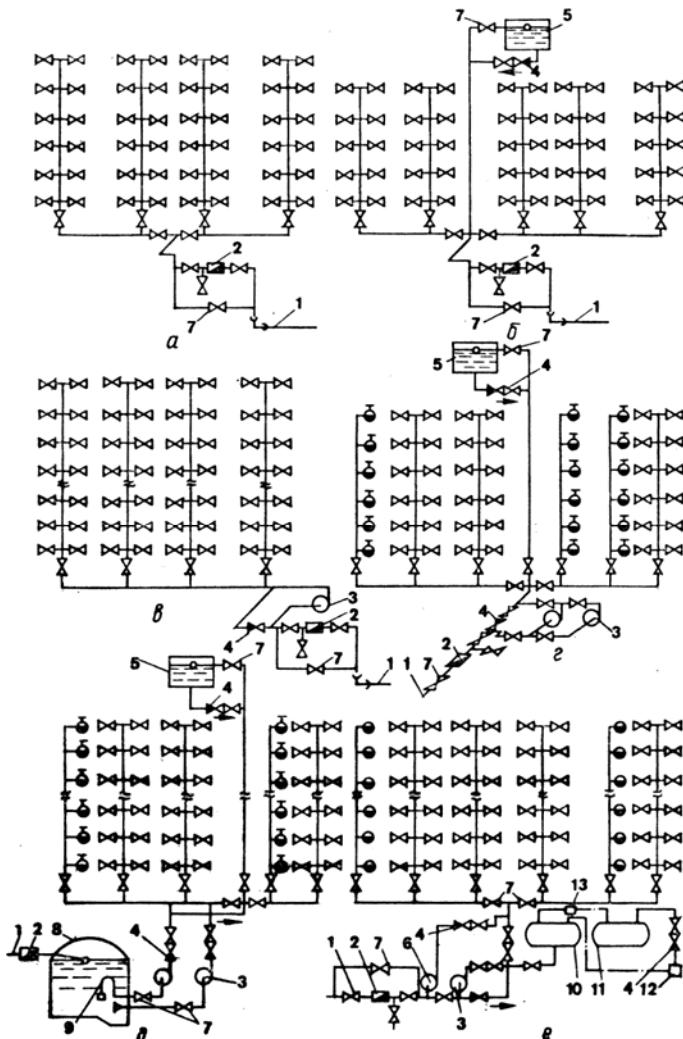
Схемы внутренних водопроводов жилых и общественных зданий:
